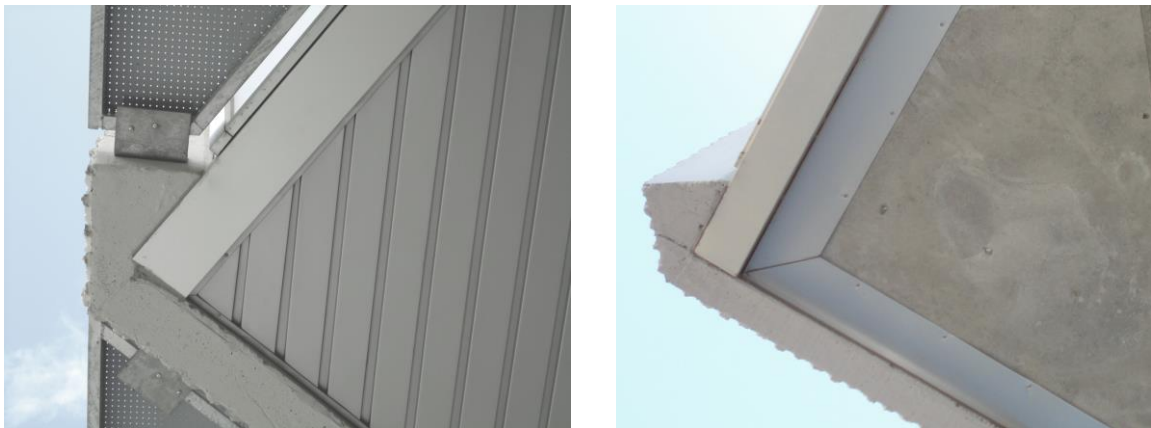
Vista de los dientes de sierra desde la parte inferior. Zona con chapa y con hormigón visto. Imagen propia.
